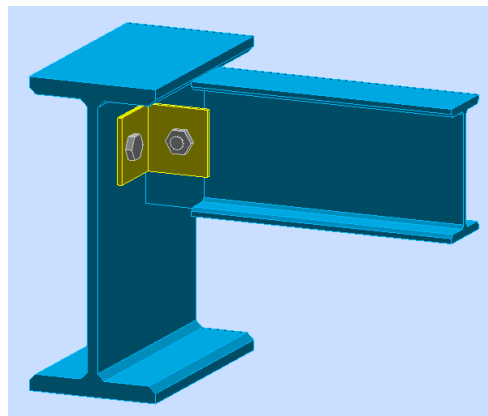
Diseño unión viga interior inferior-viga (10m)
